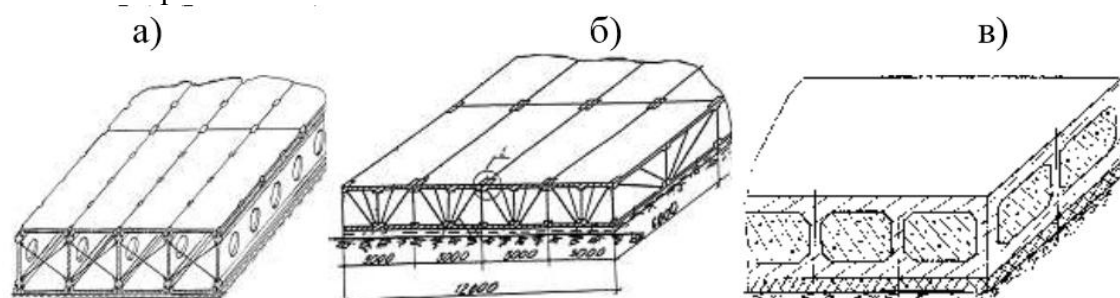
Пространственные фундаментные платформы(ПФП)для строительства на слабых и вечномёрзлых грунтах: а) сборная железобетонная платформа (патент РФ на полезную модель No 38789); б) сборная сталежелезобетонная фундаментная платформа(патент РФ на изобретение No 2206665); в) монолитная фундаментная платформа с утеплителем.
